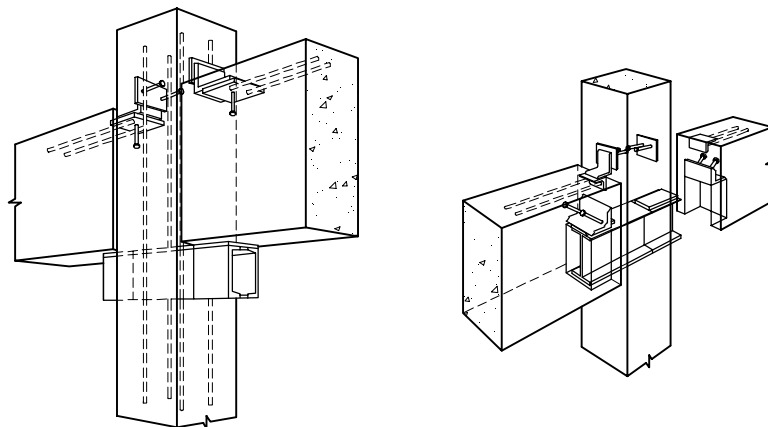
Ligação viga - pilar com cantoneira metálica soldada às chapas existentes [21]
